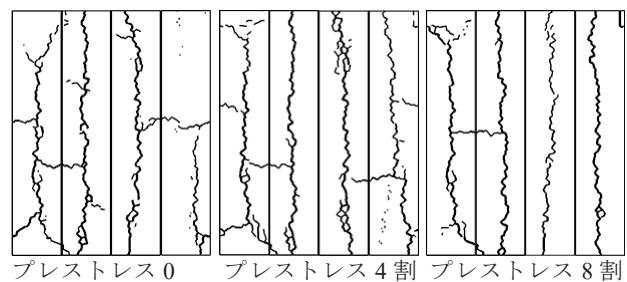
鋼材腐食+降伏時の表面ひび割れ展開図
